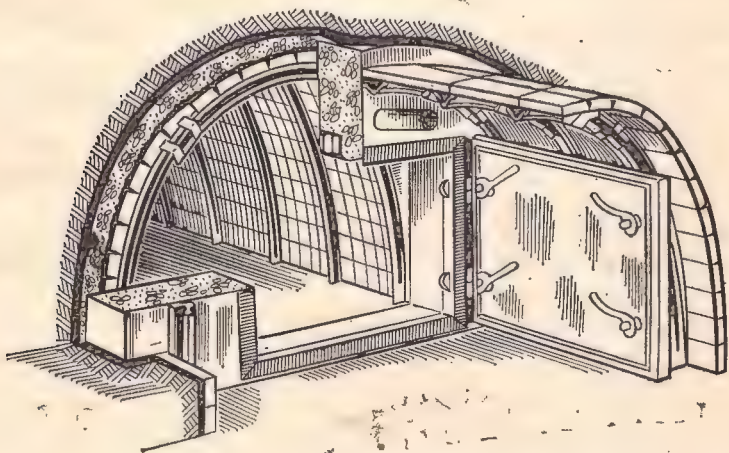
Железобетонная защитно-герметическая перемычка с защитно-герметической дверью
